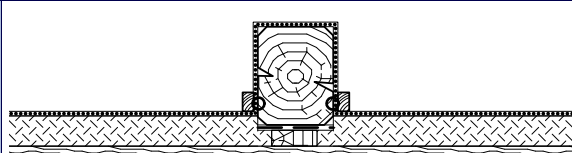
Dampfbremse einbauen – Zwei Varianten
